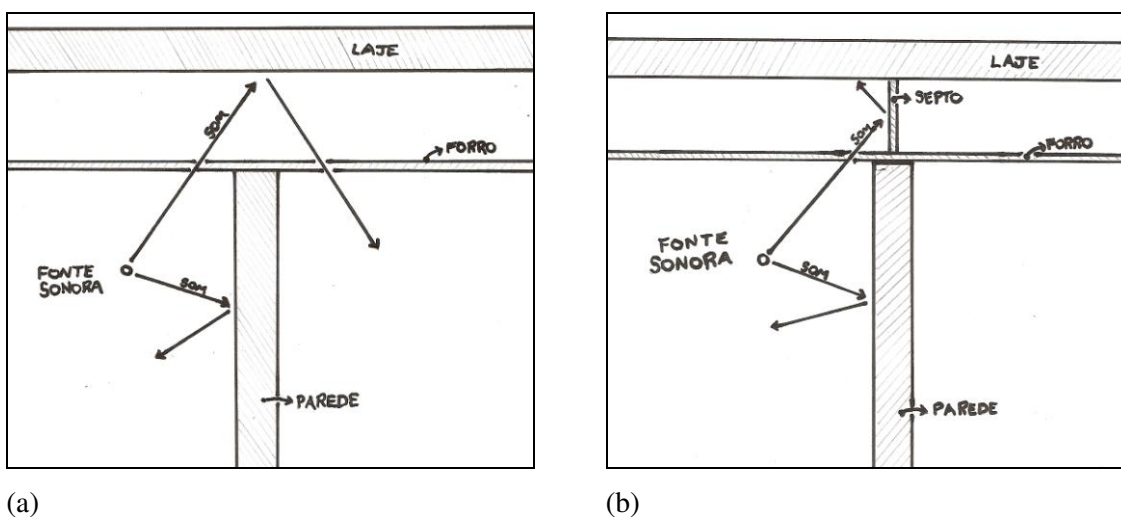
(a): Flanking entre parede e teto. (b): Septo entre parede e teto, impedindo o flanking.
